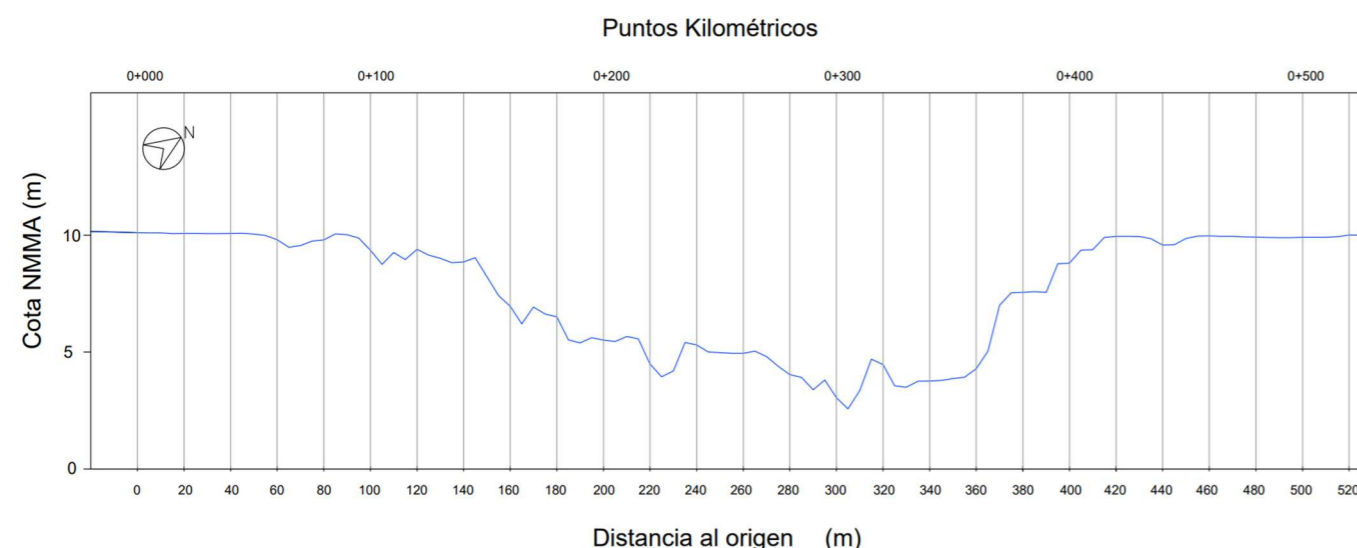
Perfil de elevación del terreno, nótese la escala vertical 10 veces mayor a la horizontal.
